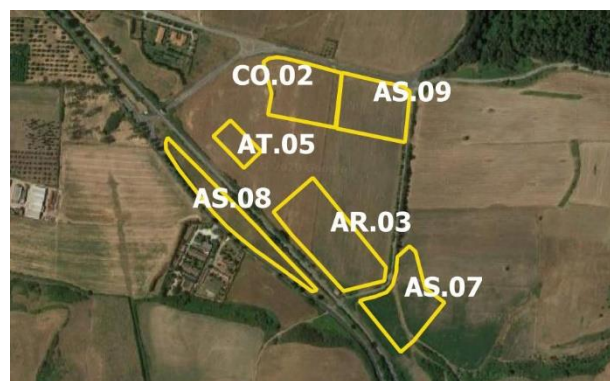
Localizzazione delle aree di cantiere fisso a Vigna di Valle, via dell'Anguillara
